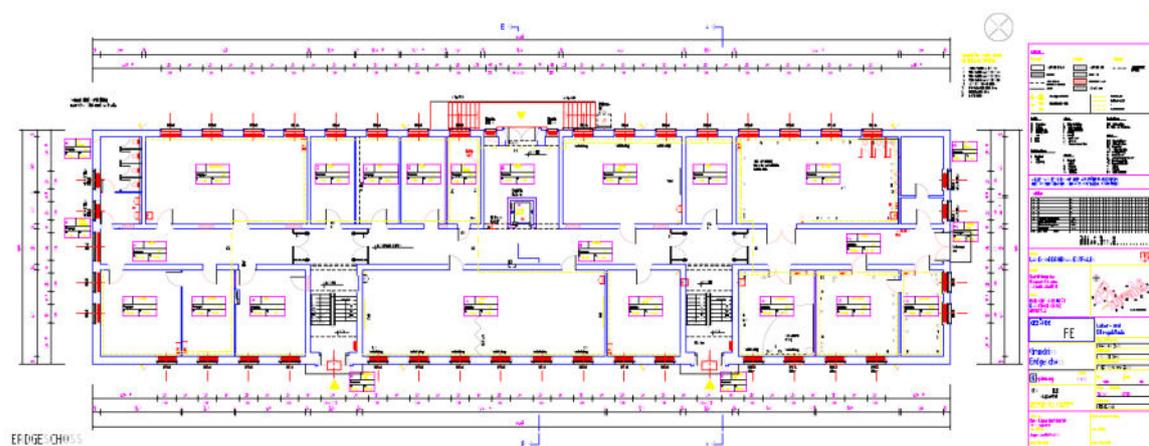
Grundrissplan Erdgeschoss, Gebäude FE
